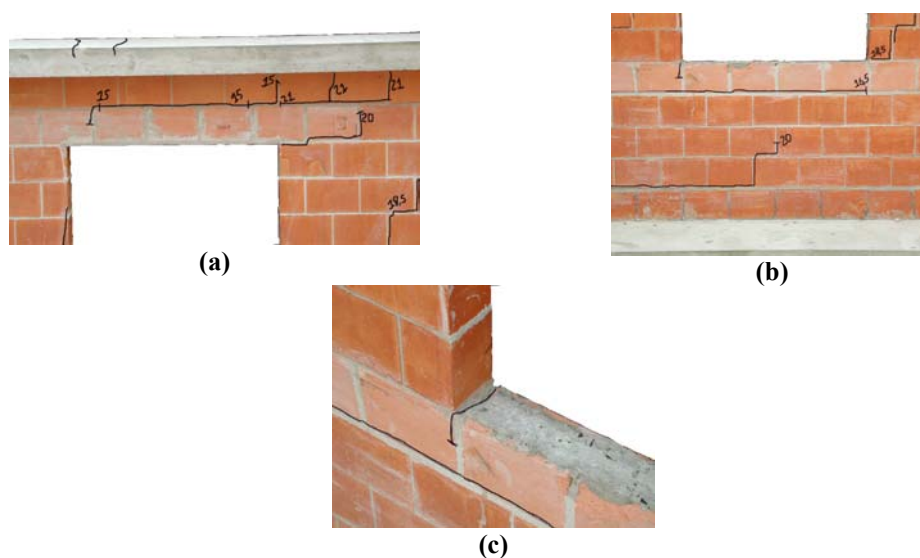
Fissuração dos lintéis do modelo PJS2: (a) Lintel superior; (b) Lintel inferior e (c) Detalhe da fissura na contraverga.
